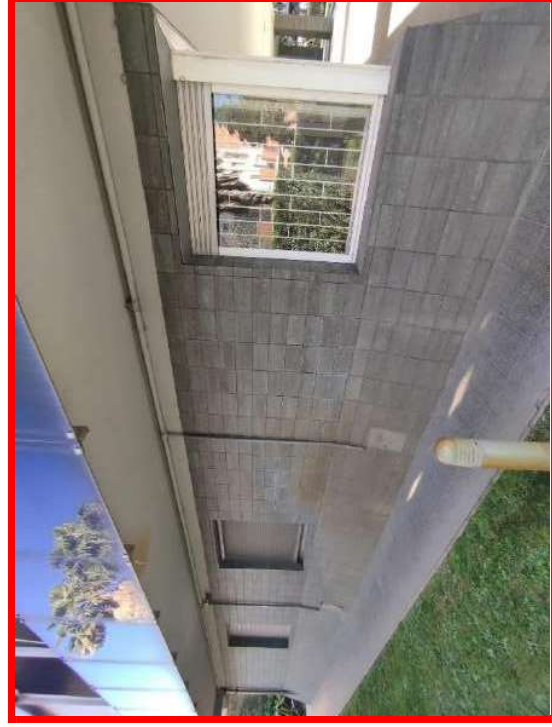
VISTA PROSPETTO SUL GIARDINO CONDOMINIALE
